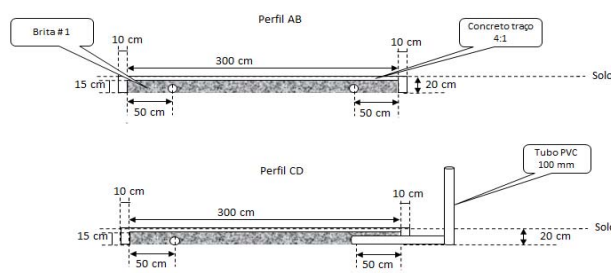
Planta Baixa do Sistema Passivo de Pressurização do Solo.
